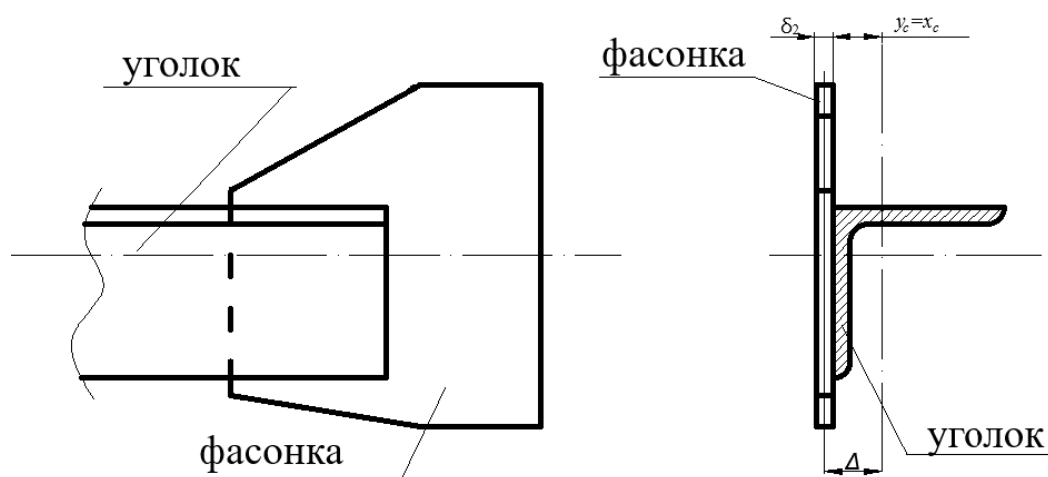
Схема известной конструкции соединения уголка с фасонкой [1].
